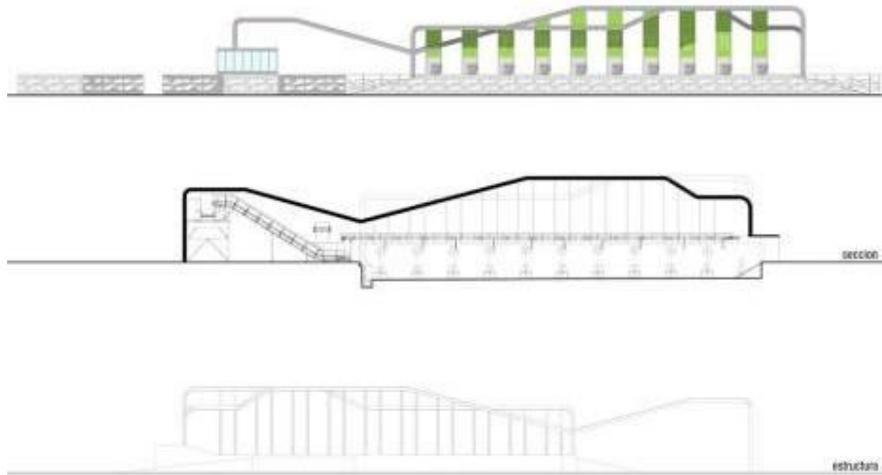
Corte transversal de la Fachada principal de la planta de residuos sólidos punto verde. Fuente: www.peruarki.com, 2014
